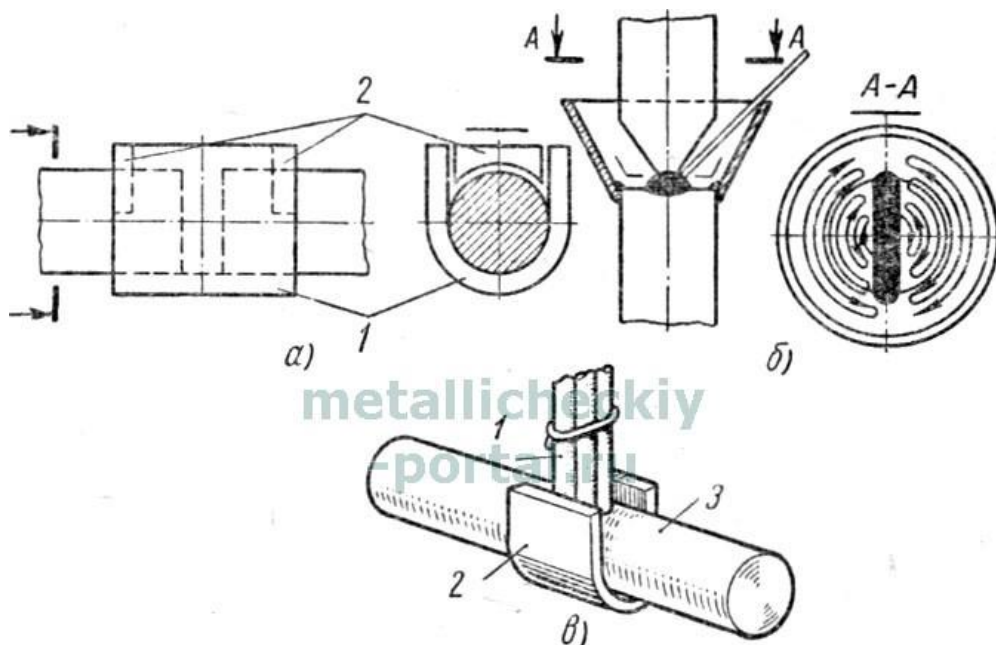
Сварка ваннным способом стержней арматуры:
